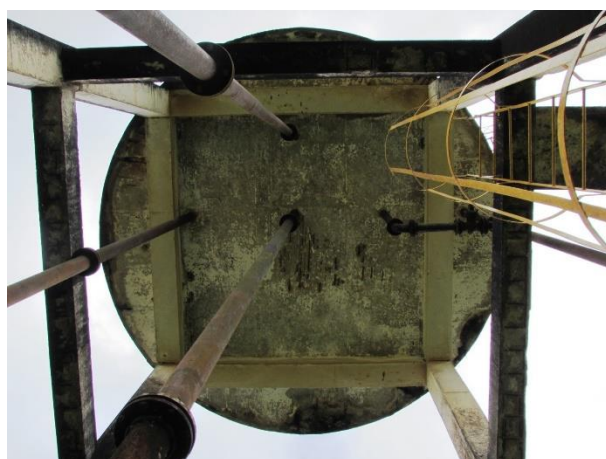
Vista geral inferior da laje da cuba do reservatório com corrosão da armadura
